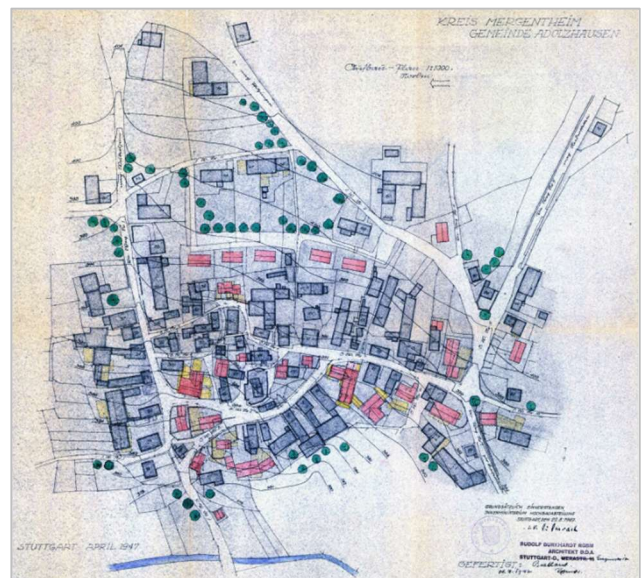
Lageplan Bebauungsplan ‘Aufbauplan 1947’,
